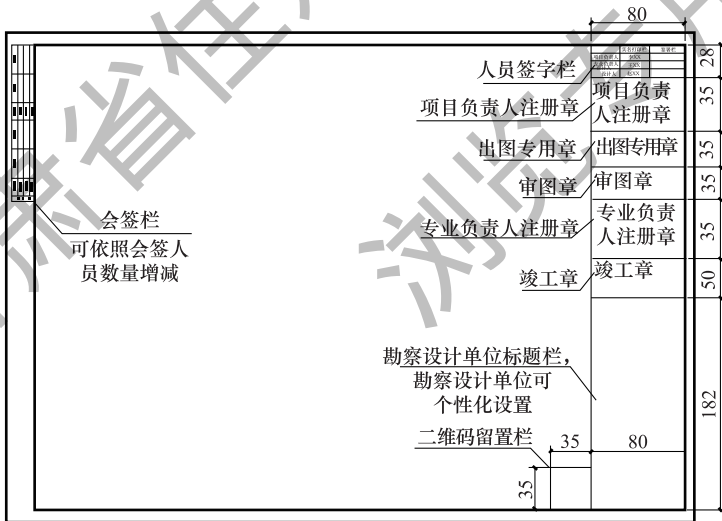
A2 图幅横式幅面标题栏组合布置图 (单位:mm)
